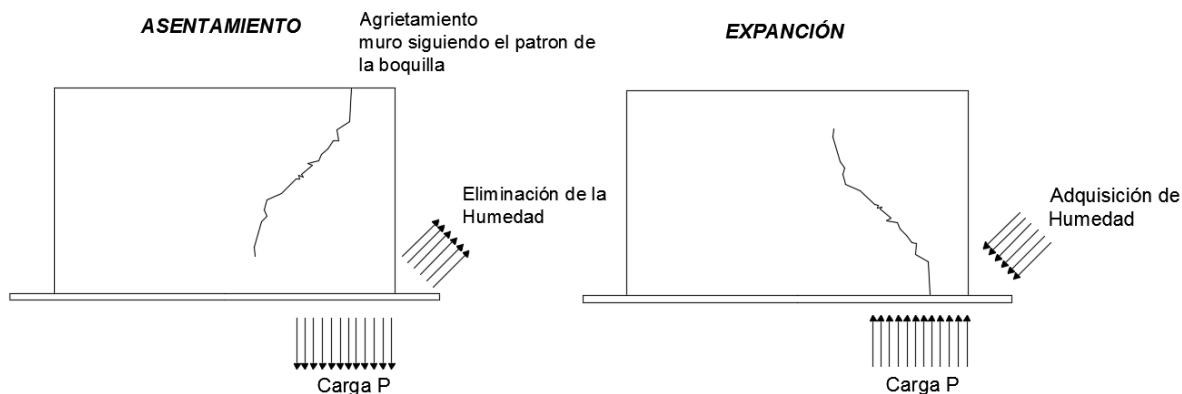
Reconocimiento de fisuras por asentamiento del terreno
